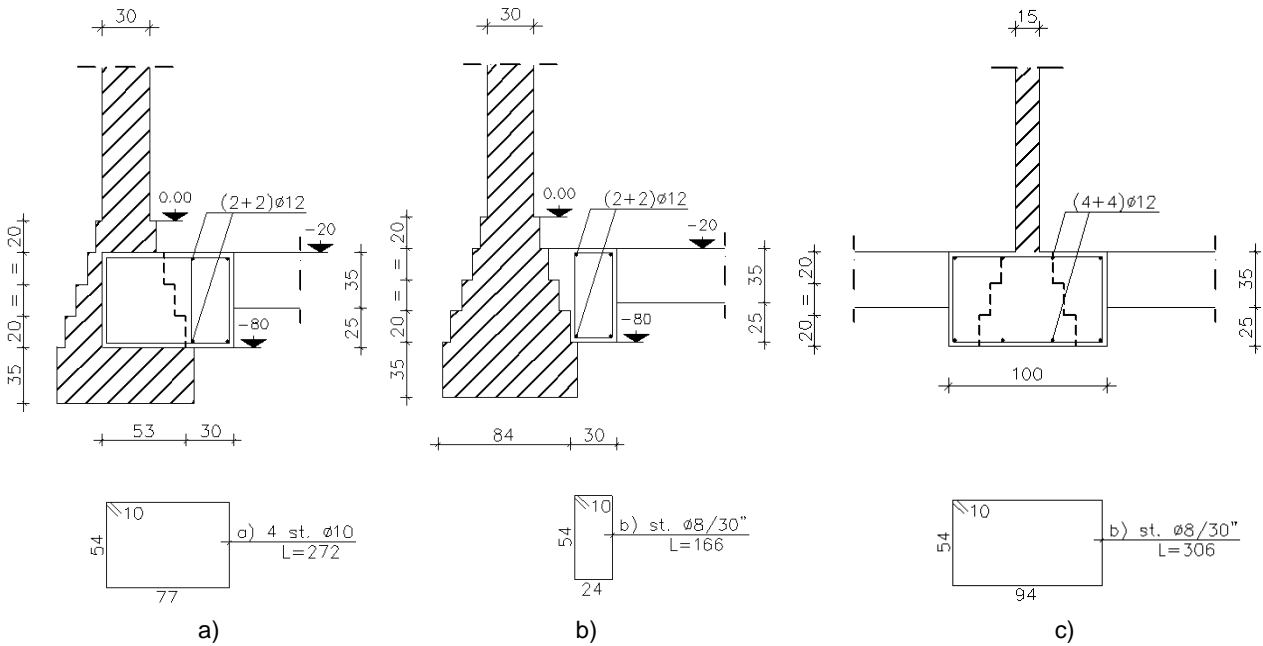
Ex-Lavanderie - stato di progetto, sezioni: a) A-A, b) B-B, c) D-D
